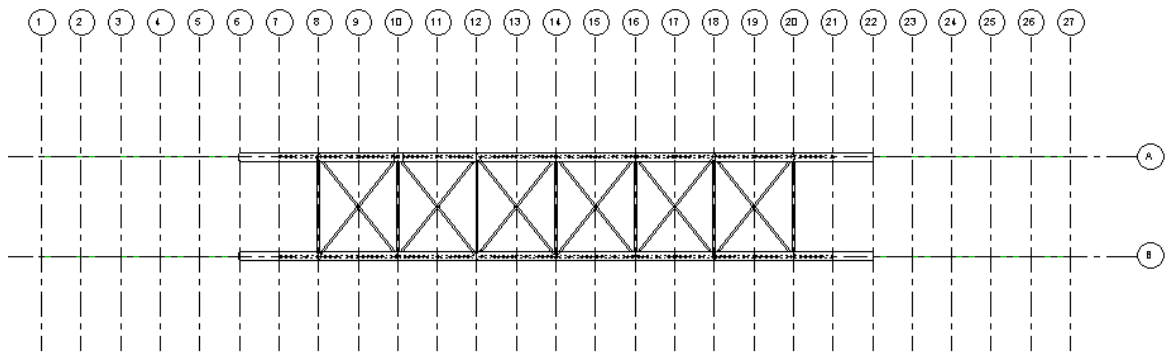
Vista en planta de las viguetas transversales superiores y tornapuntas
